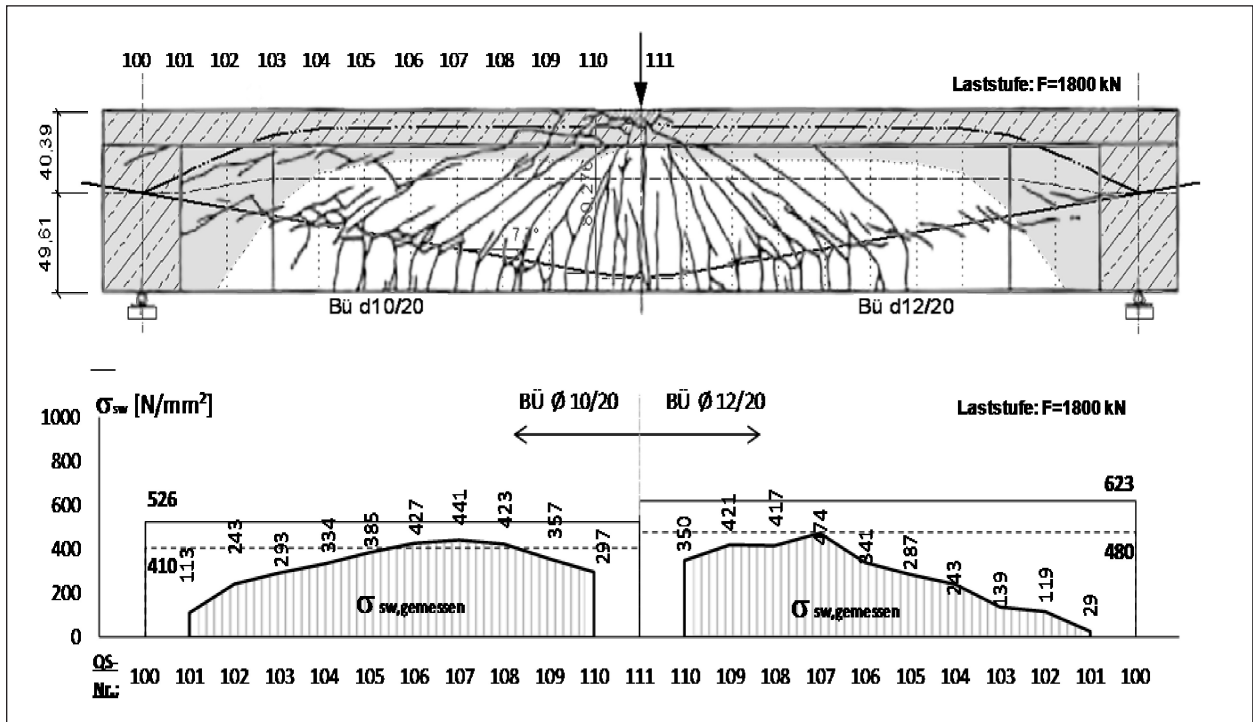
TG2, Laststufe 1.800 kN = Bruchlast
